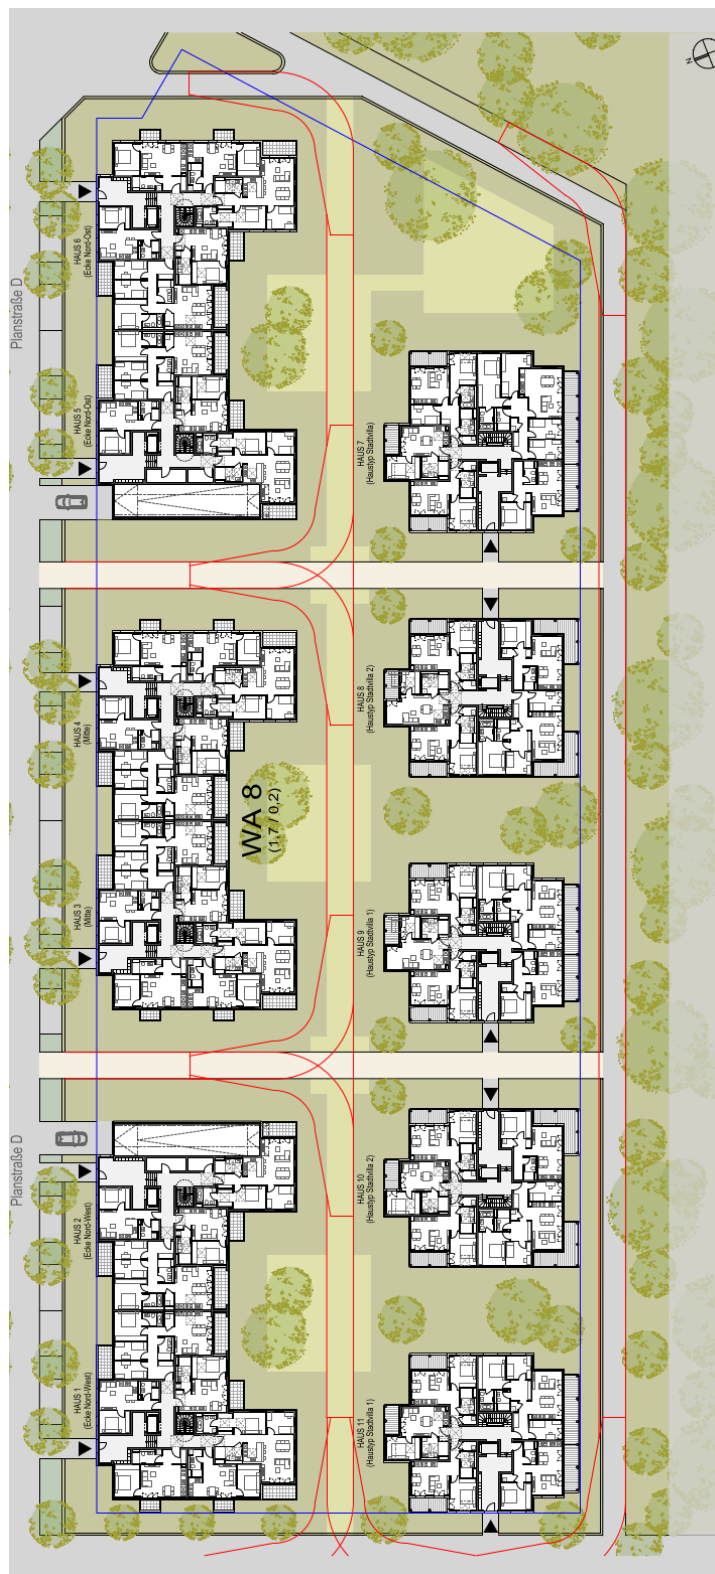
Grundriss Erdgeschoss Draufsicht WA8, Wettbewerbsstand: 15.05.2023
